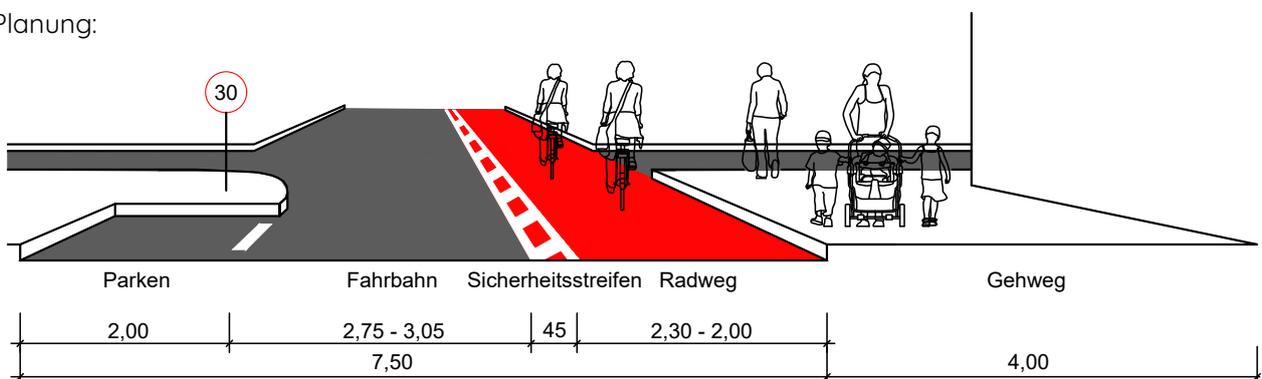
Planung: möglicher Straßenquerschnitt mit Radweg auf Straßenniveau
